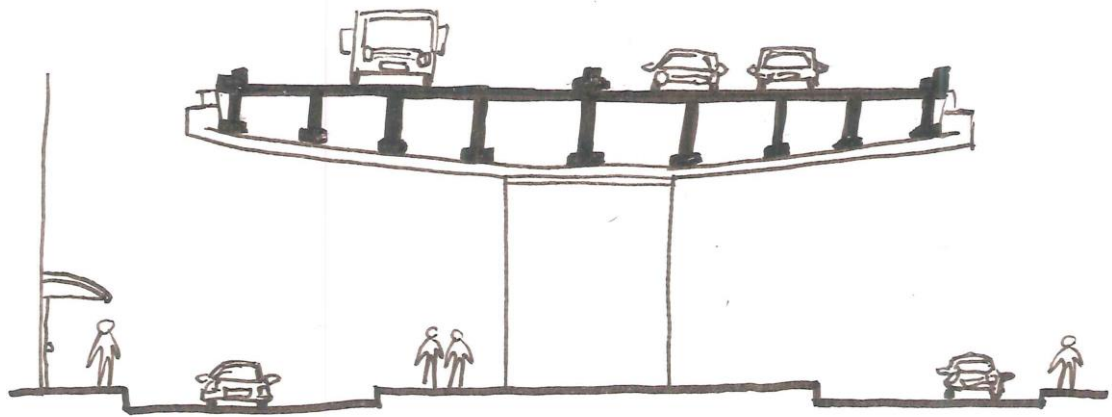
Corte do Elevado Costa e Silva (Croqui em escala)
